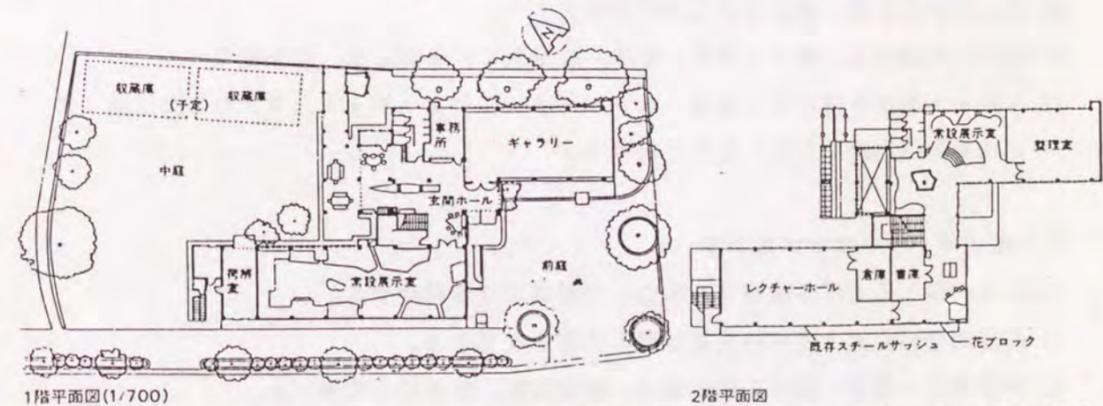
名護博物館1, 2階平面図（図面は日経アーキテクチャー'84.12.22号による）
